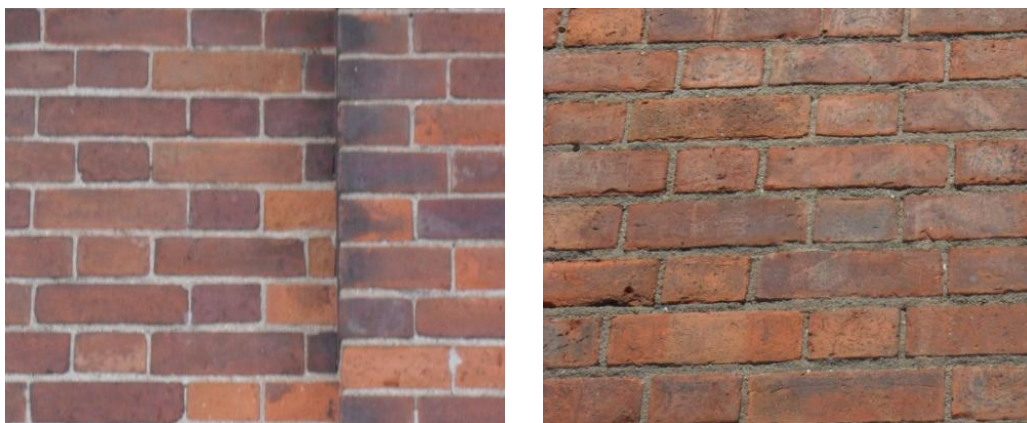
Alvenaria de tijolo na BP. Fachadas Norte (esquerda) e Sul (direita).
